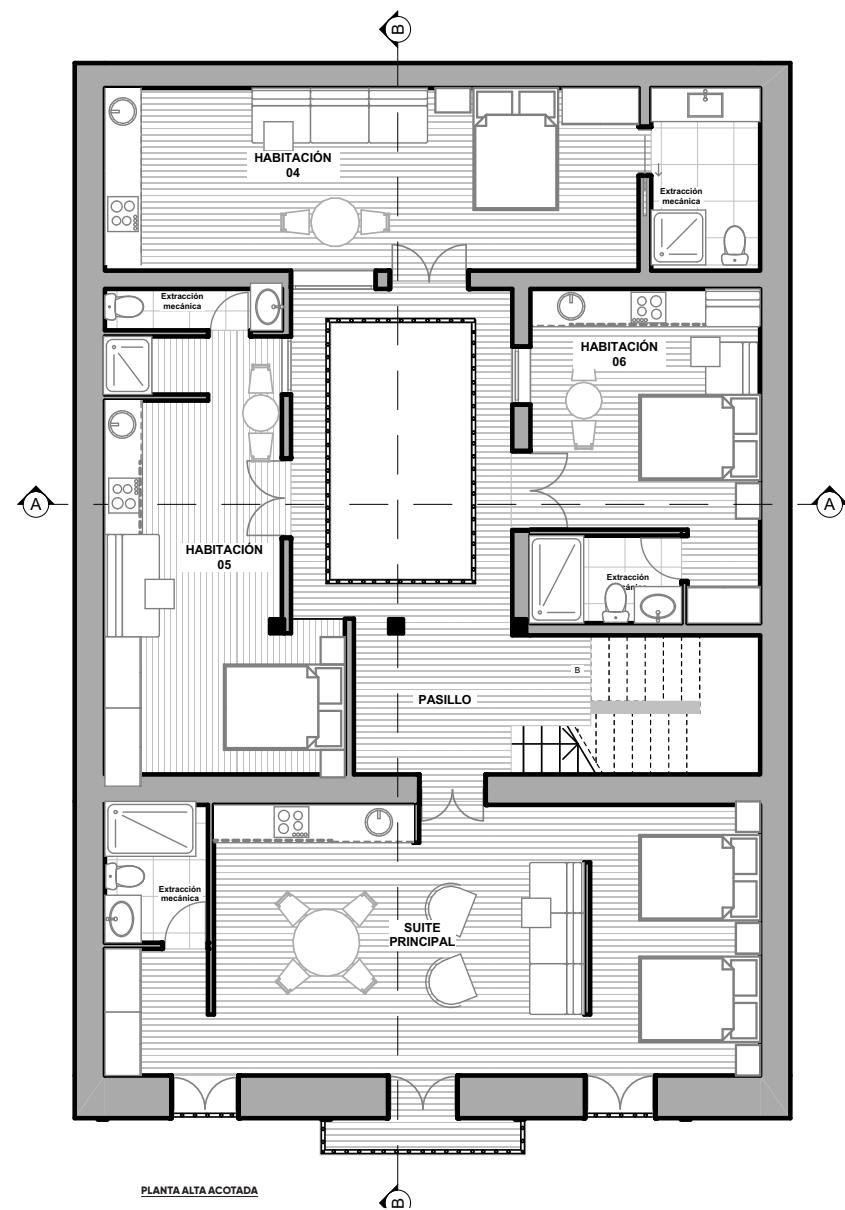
Ilustración. Planta Alta de Vivienda. Realizada por el autor
